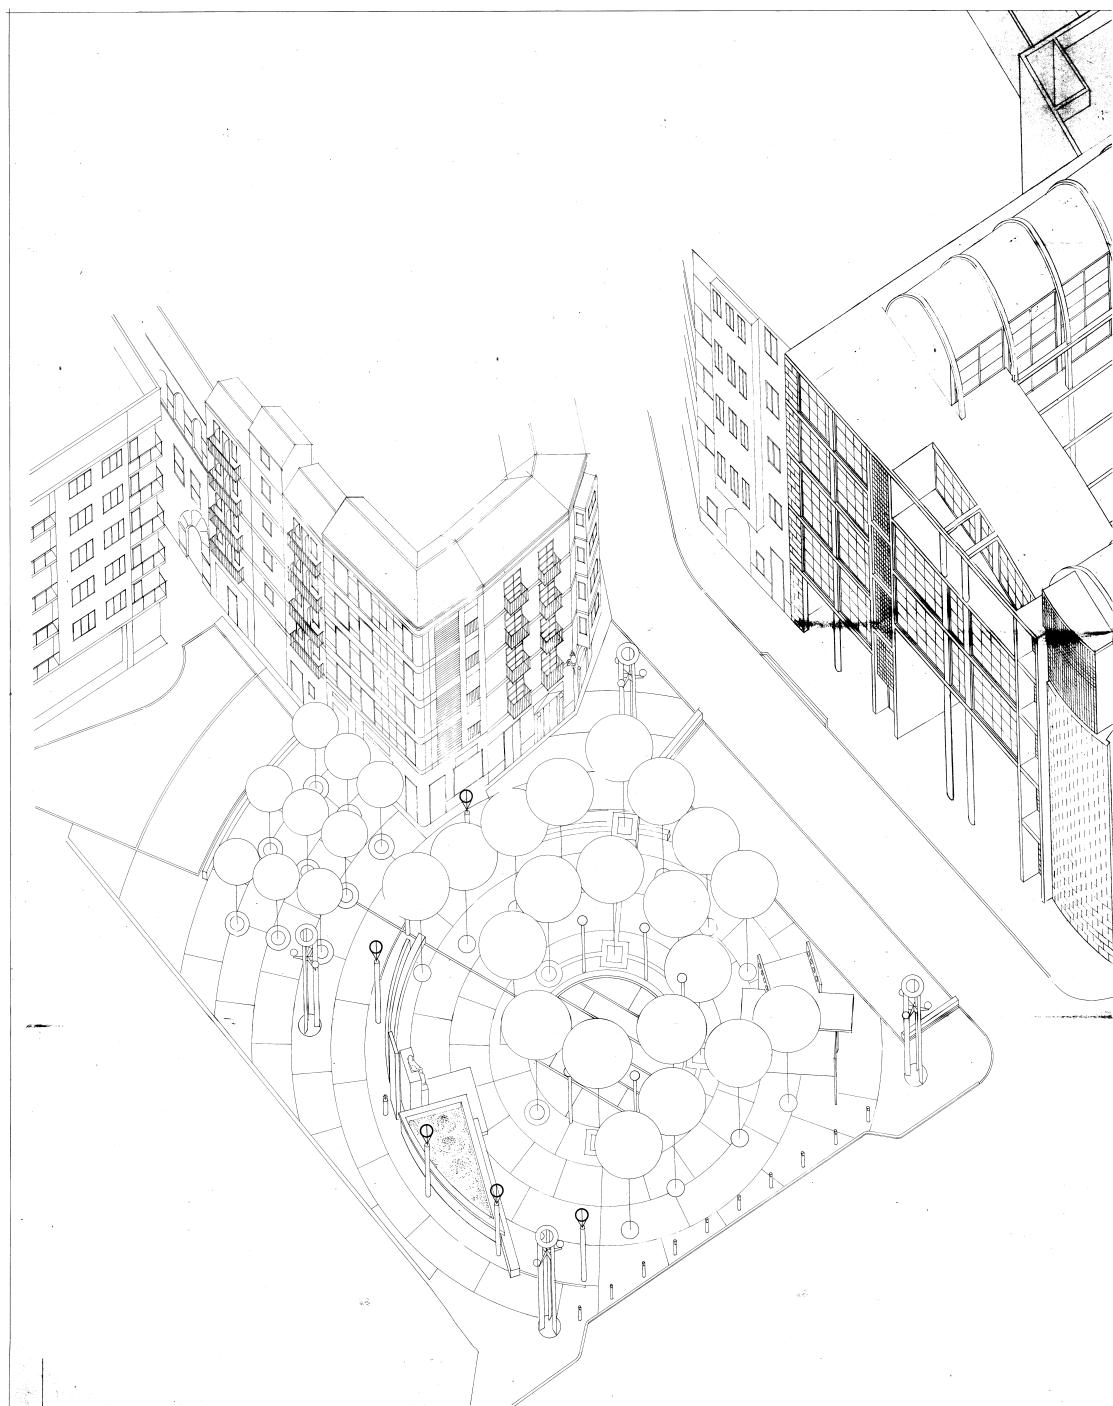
Plano de pavimento de la Plaza San Pedro Nolasco
